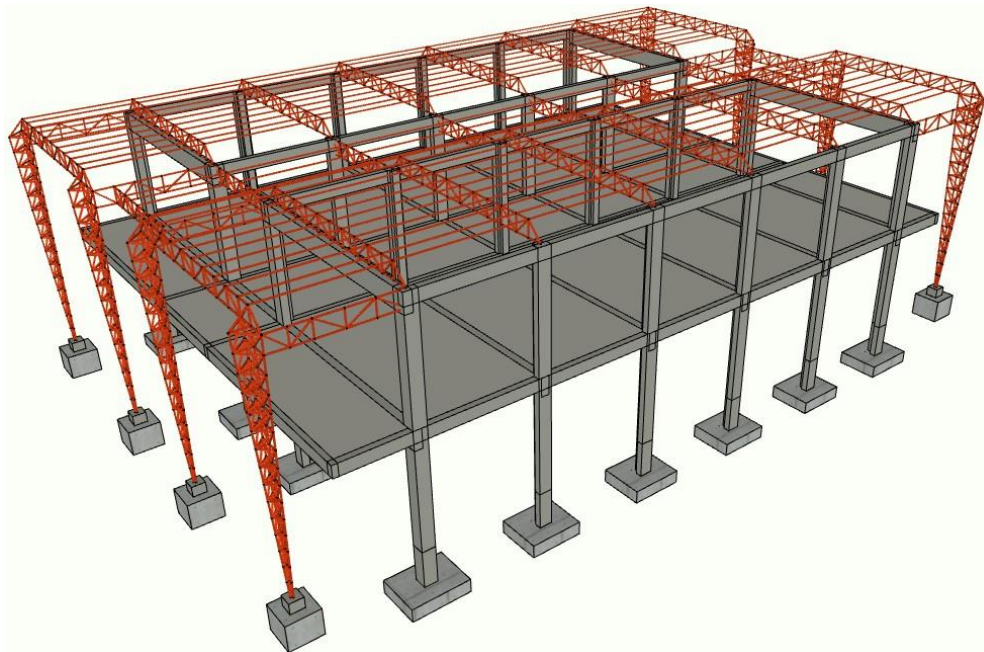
Vista 3D del modelo estructural en base a pórticos y estructura metálica integrada
